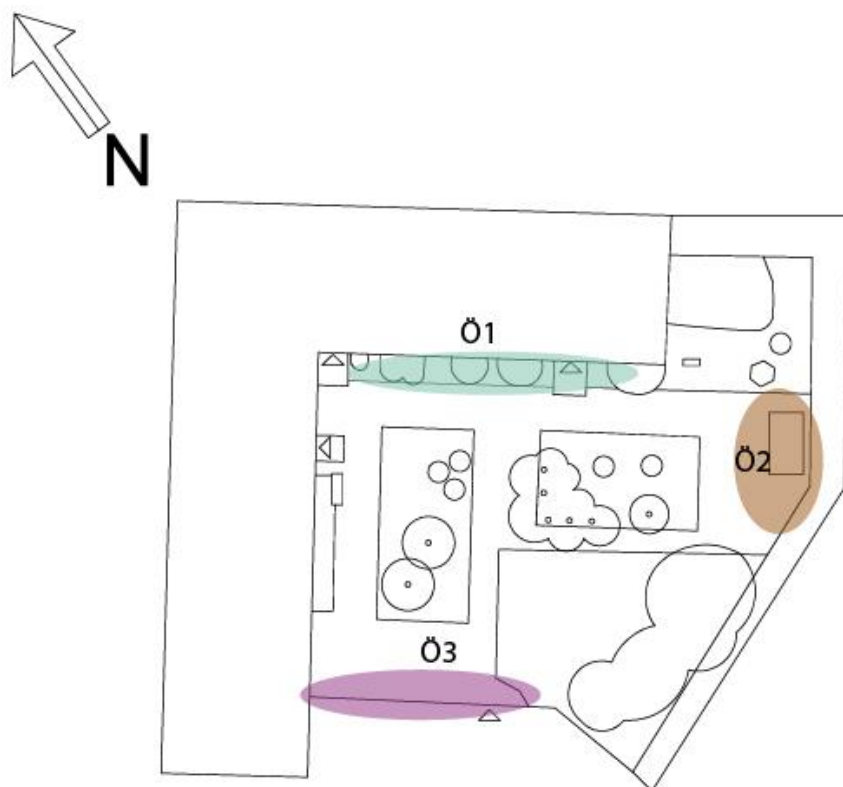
Planterings- och utrustningsplan (PLU) till Doftoasen
